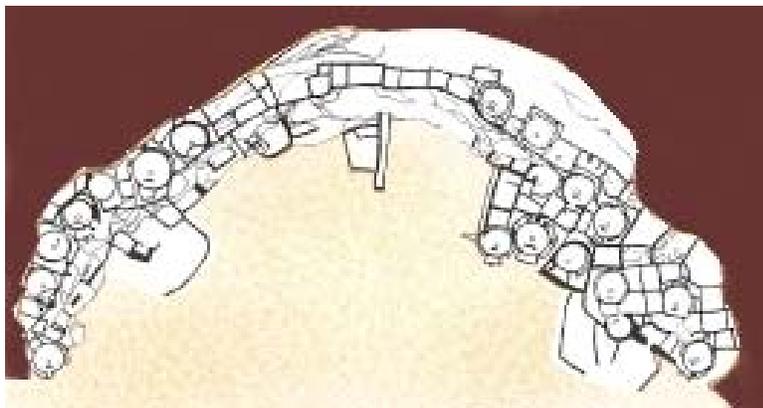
e 8. Planta e corte de Longhouse Pueblo. Fonte: Knowles, adaptado por Daniel B. Pérez, 2006
